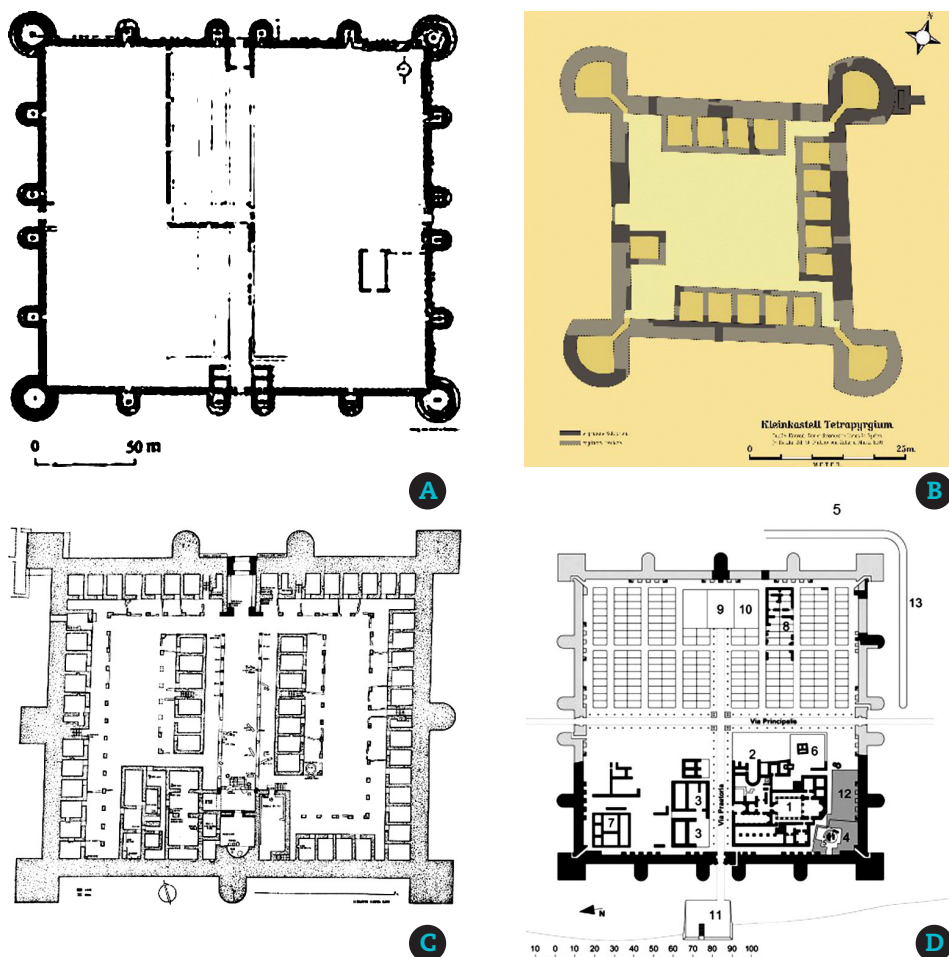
A. Planta del campamento de Dumayr, según Brünnow-Domaszewski. Escala aproximada 1/2,000. (citado en Lenoir 1999); B. Planta de Tetrapyrgium/Qusair al-Saila; C. Planta de Qasr Qarun/Dionisio (Según Schwartz 1969); D. Plan esquemático de Nag al-Agar (Según Karelin 2011).
